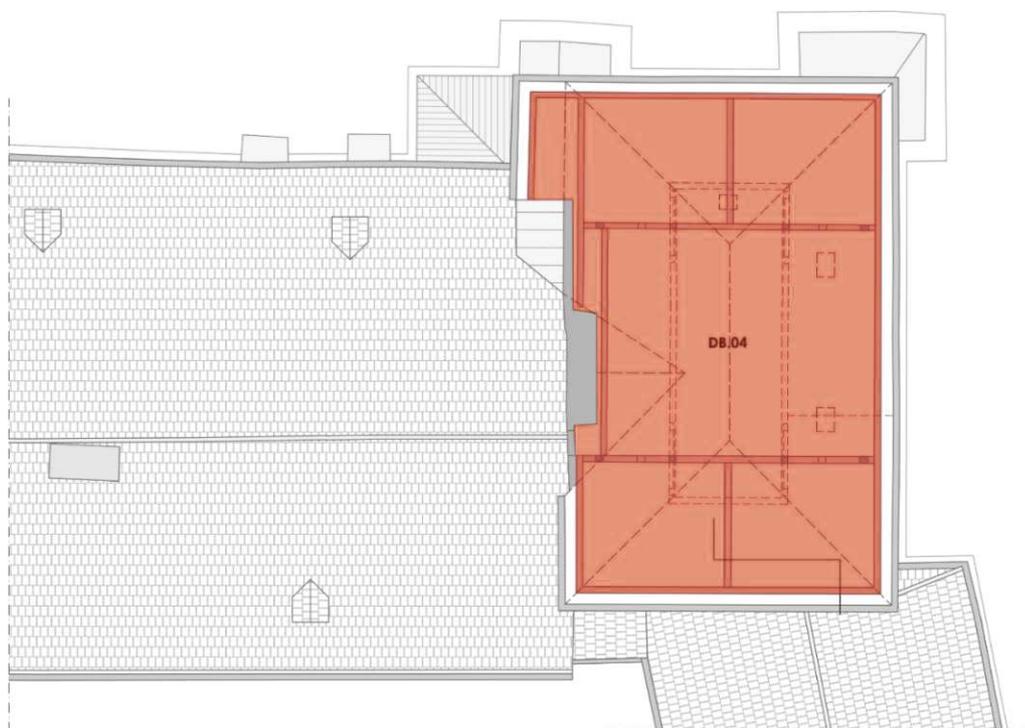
Dachboden Turmgebäude Übersichtsplan- DB.04
